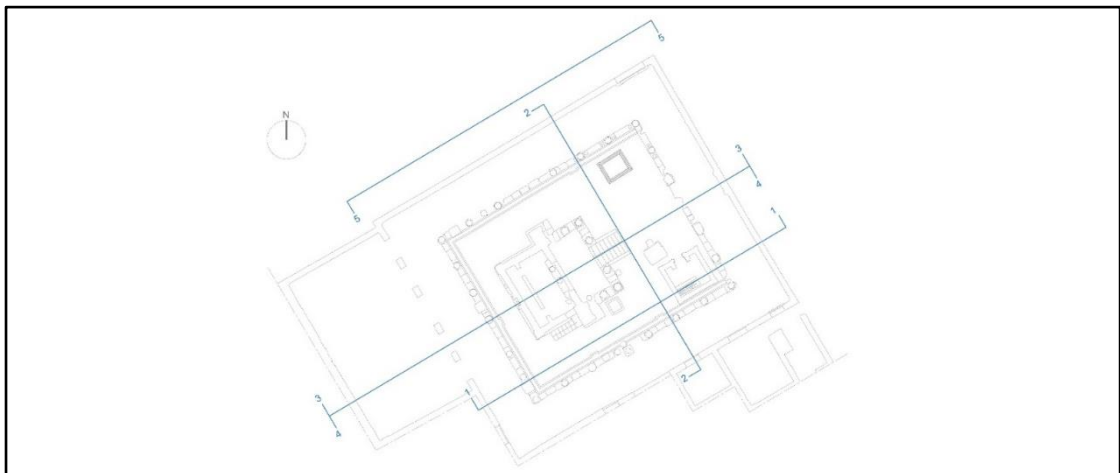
Posizione delle sezioni-prospetto della casa del Tempio di Iside
